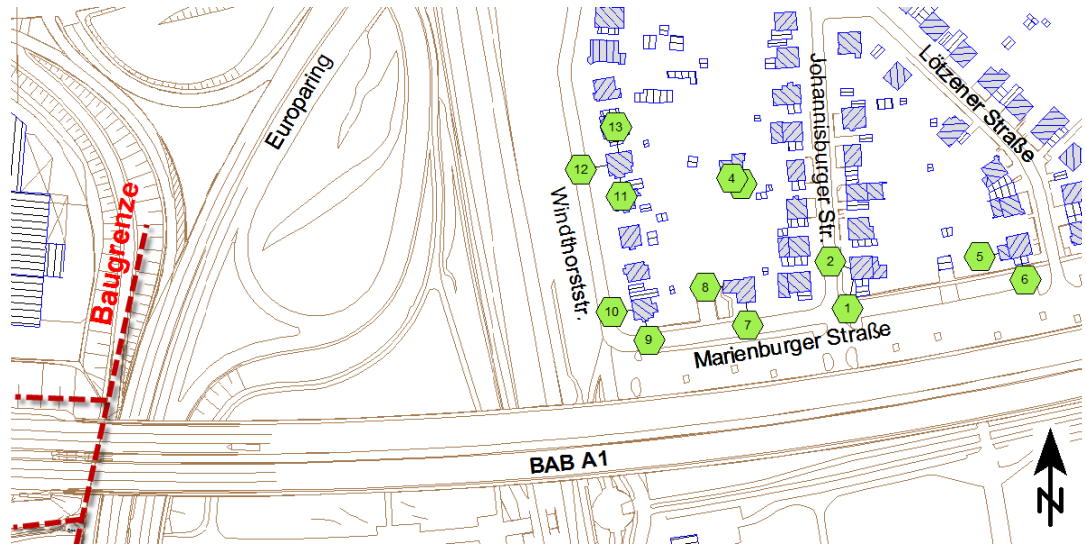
Lageplanausschnitt der östlichen Baugrenze
